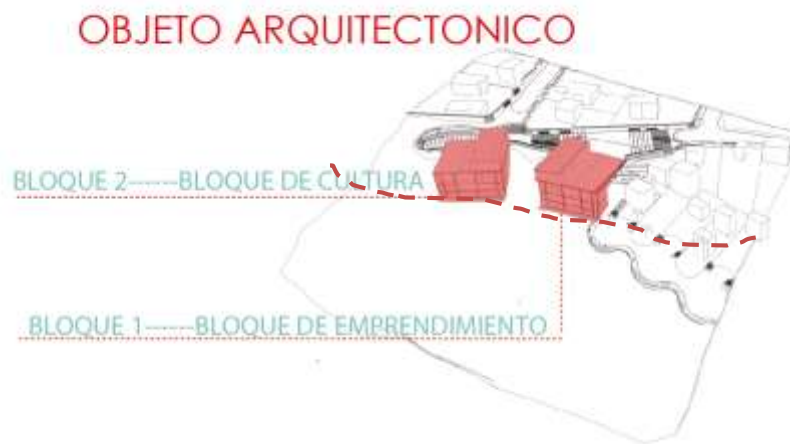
Esquema del lugar de emplazamiento del proyecto arquitectónico.
